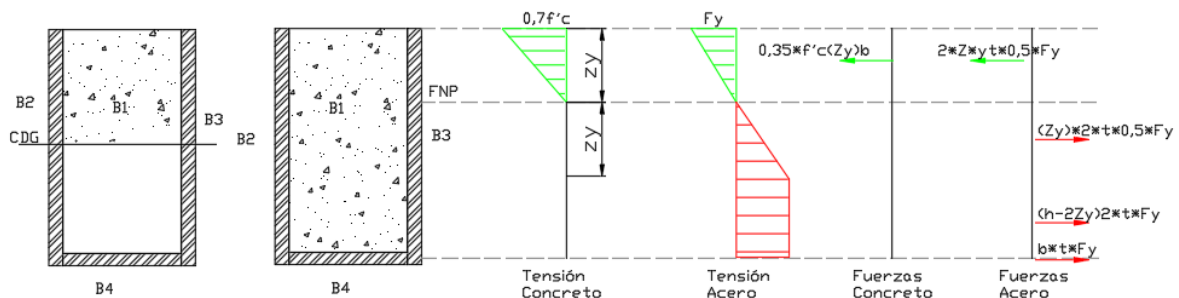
Distribución de tensiones y fuerzas en la Sección N°1 en el rango plástico.
